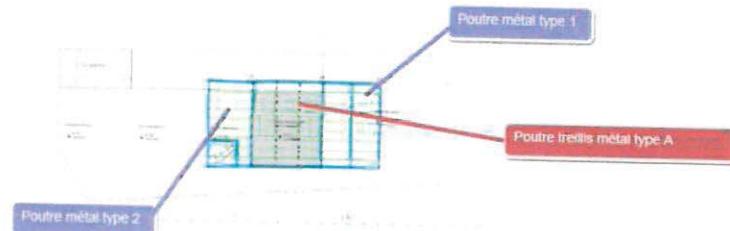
Extrait de la toiture-terrasse – Localisation des poutres métalliques de la zone locaux commissions
